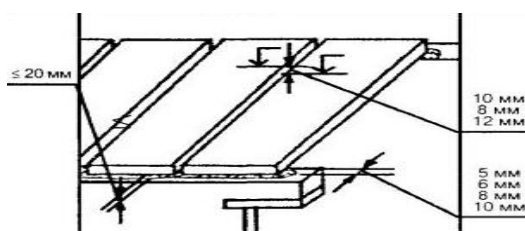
Схема допускаемых отклонений при монтаже плит перекрытия
